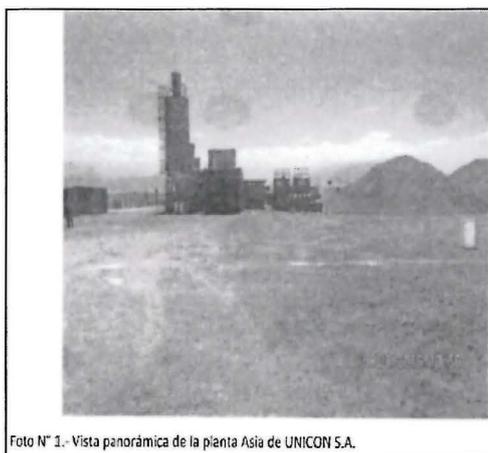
Vista panorámica de la planta Asia de UNICON S.A.
